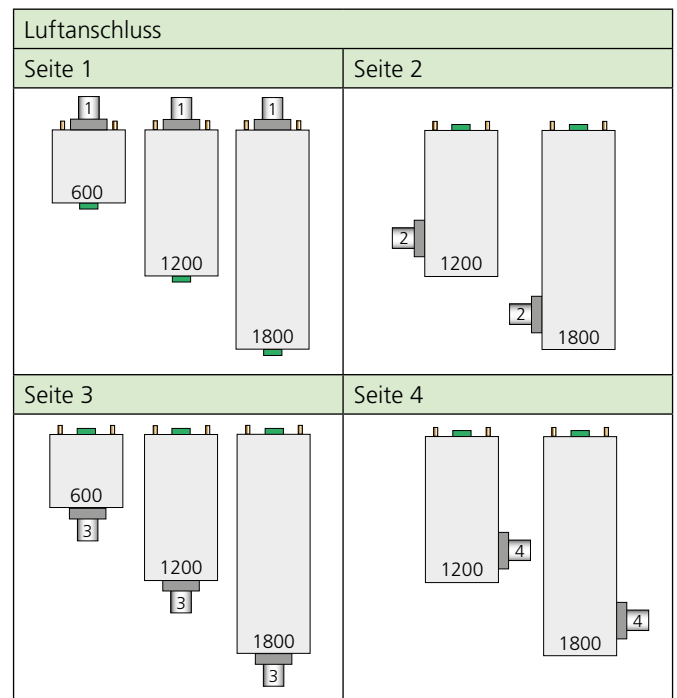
Auswählbare Luftanschlüsse (Draufsicht)
